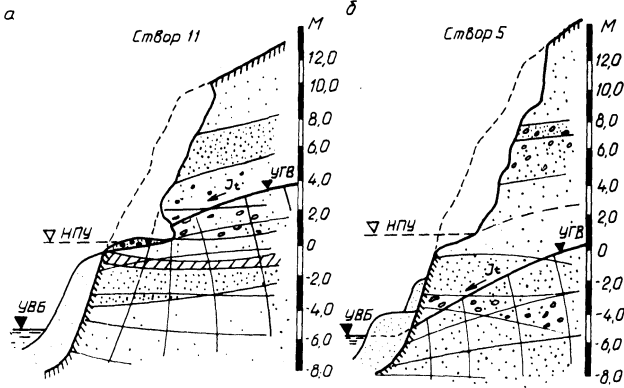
Разрушение береговой отмели под действием грунтовых вод на водохранилище Волковичи:
